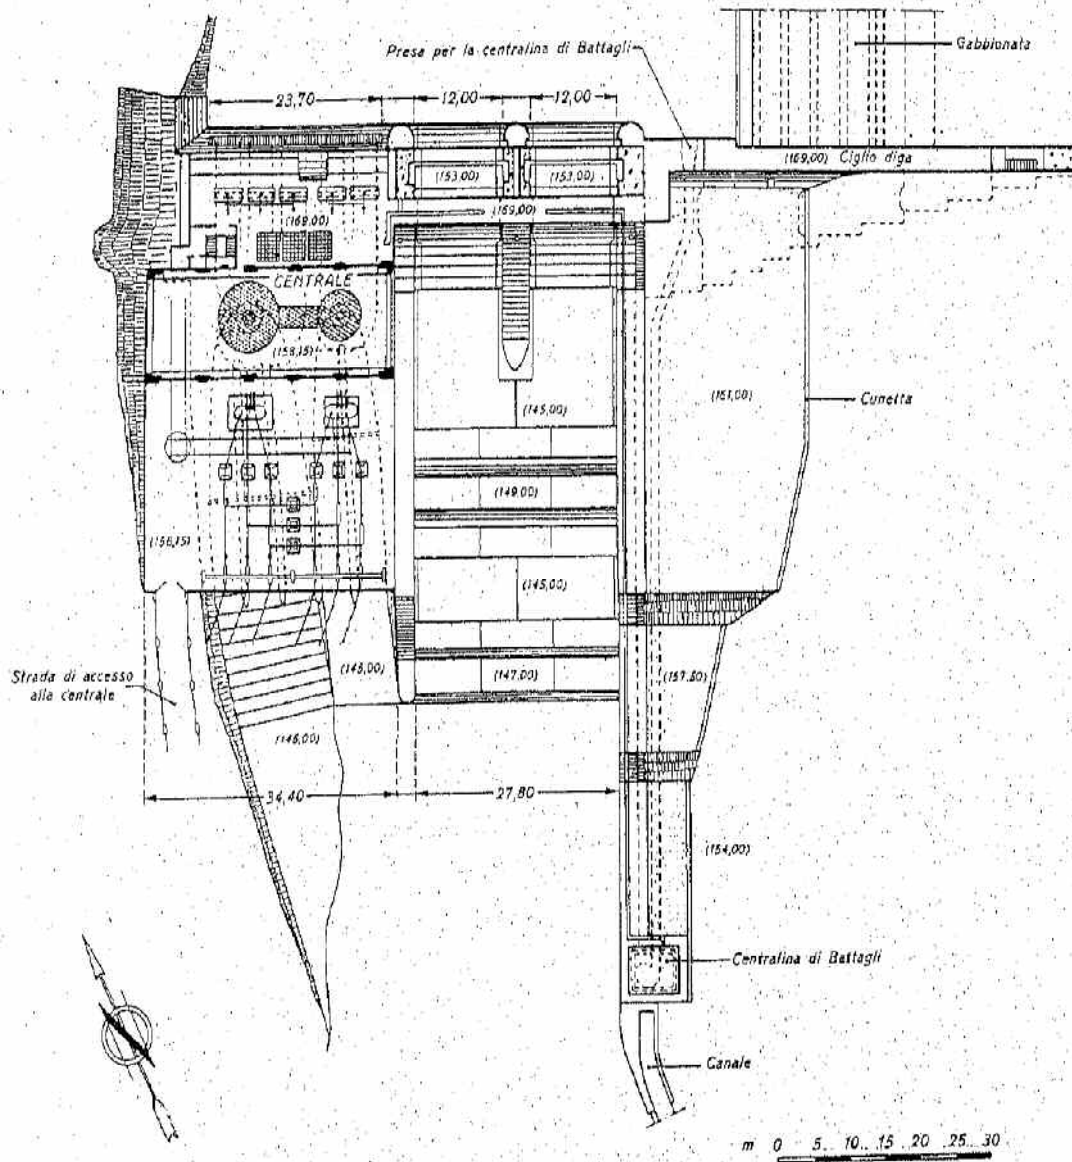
Planimetria dello sbarramenti e delle opere di scarico
